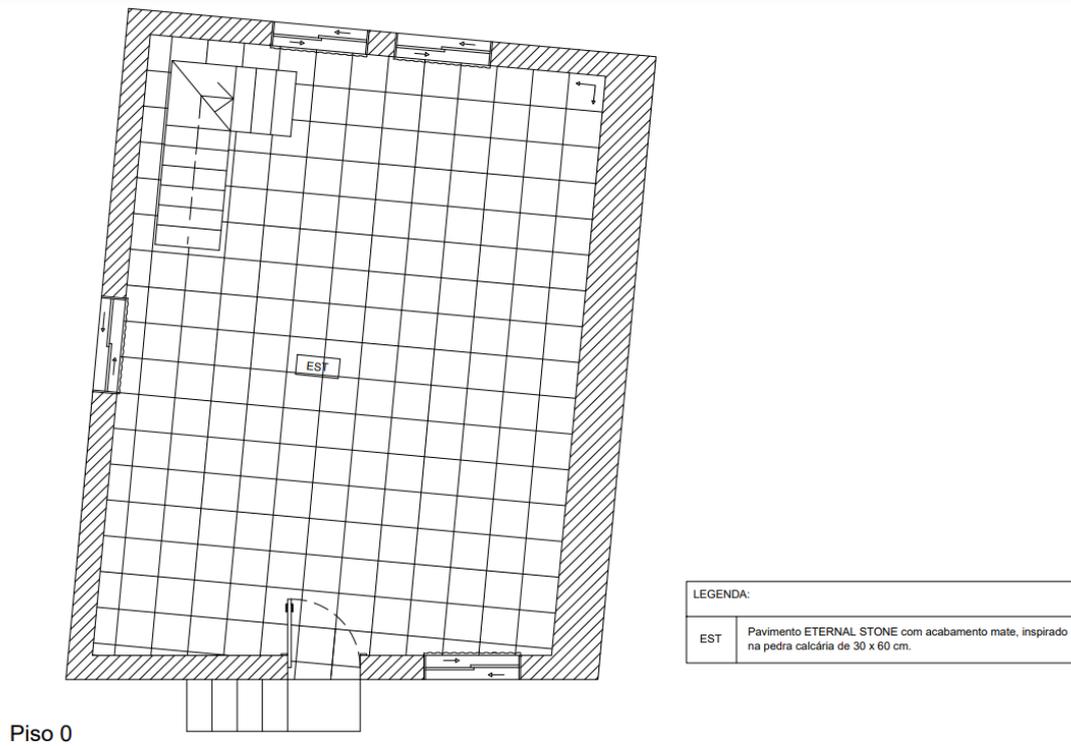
Planta de pavimento piso 0. Fonte: Maria Leonor.
